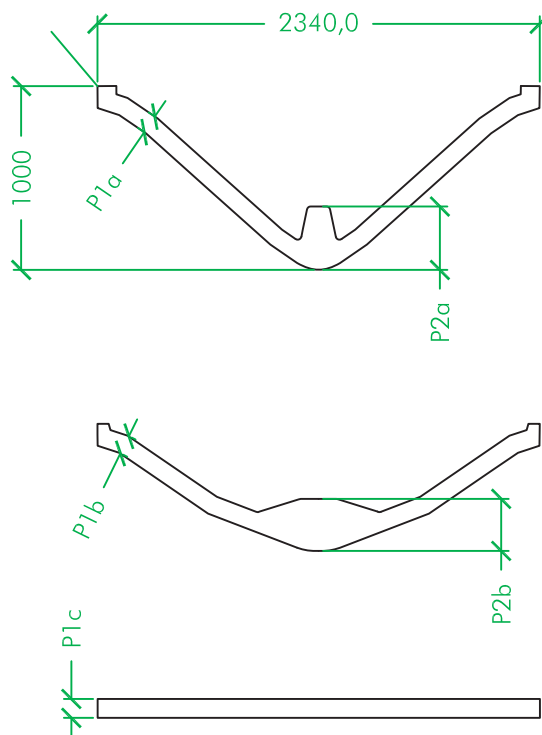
Seccions que defineixen la geometria de la biga. A dalt: secció central (A). Al mig, secció intermitja (B). A sota, secció de l'extrem (C).
